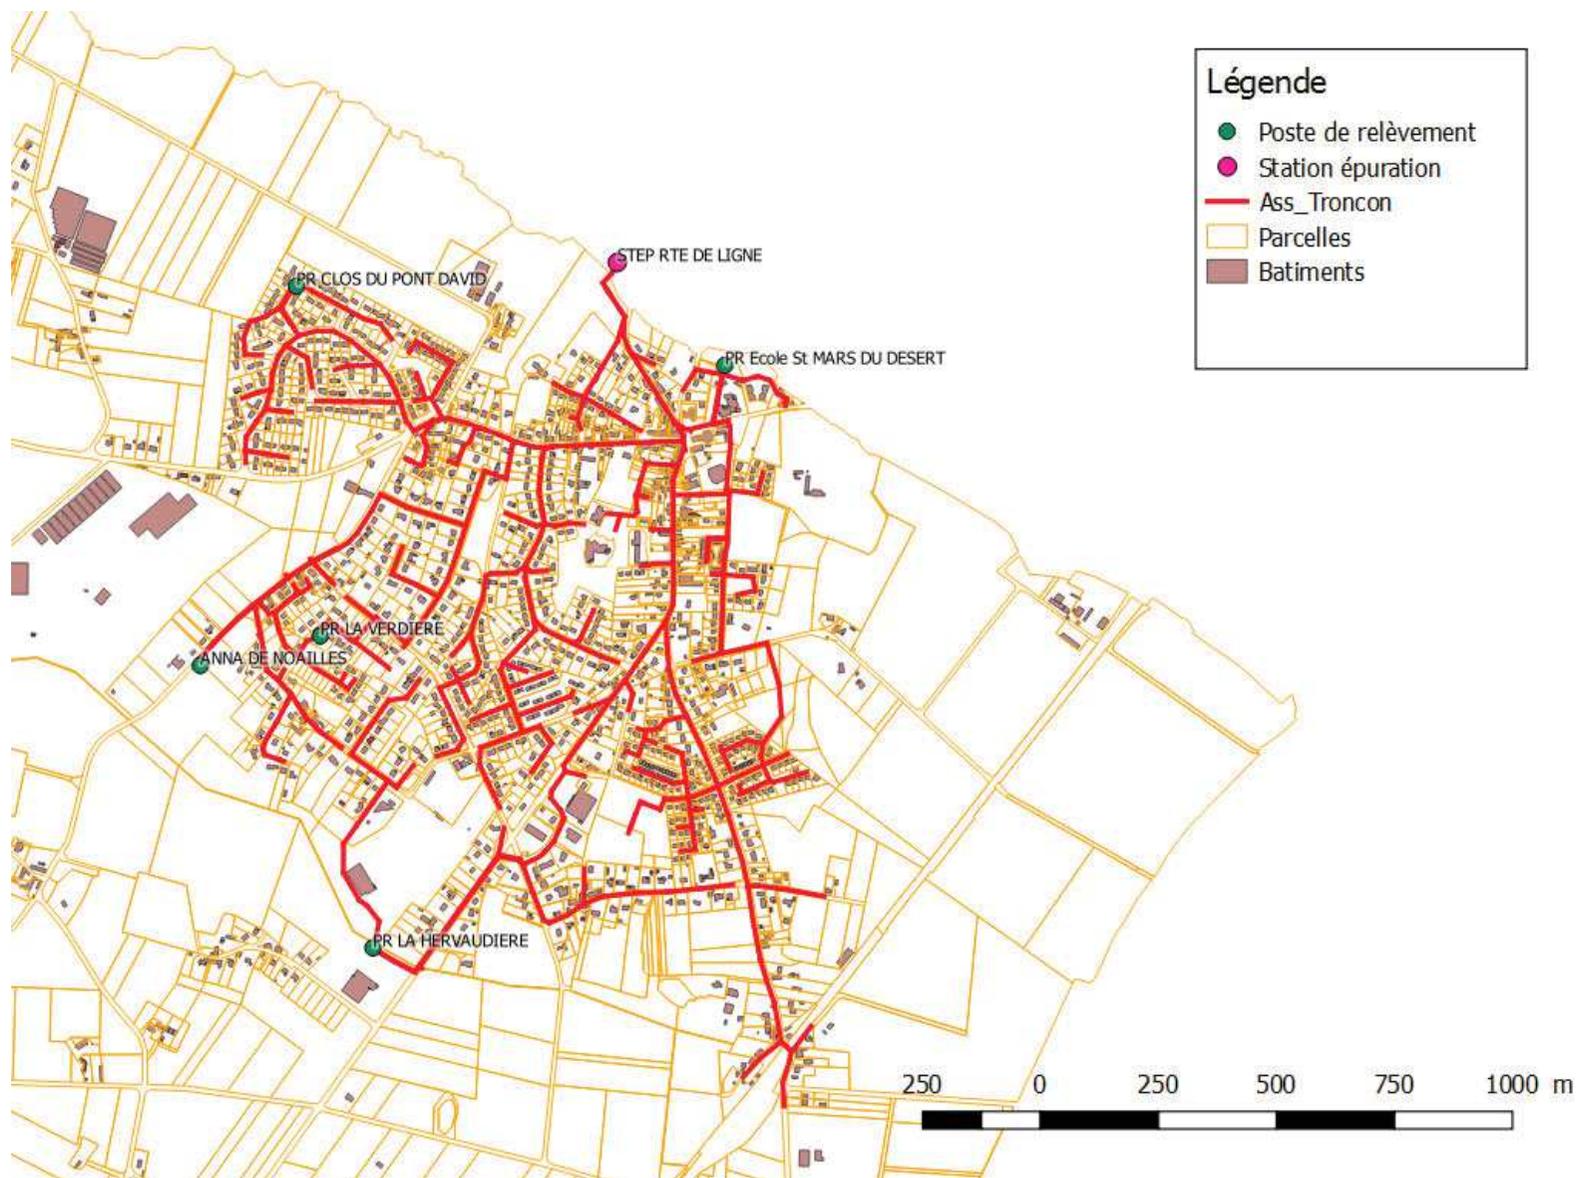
Plan du réseau d'assainissement de la STEP du Bourg (Rouge de Ligne)
